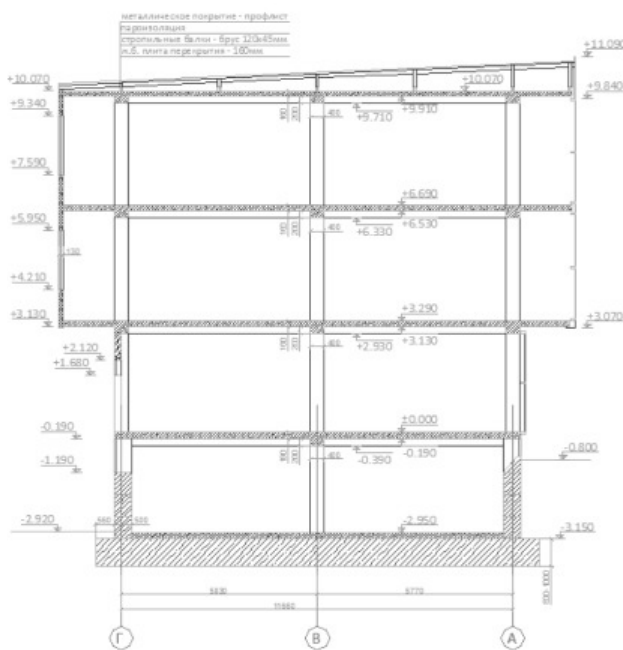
Поперечний розріз будівлі за попереднім проектом / Cross section of the building according to the previous project
